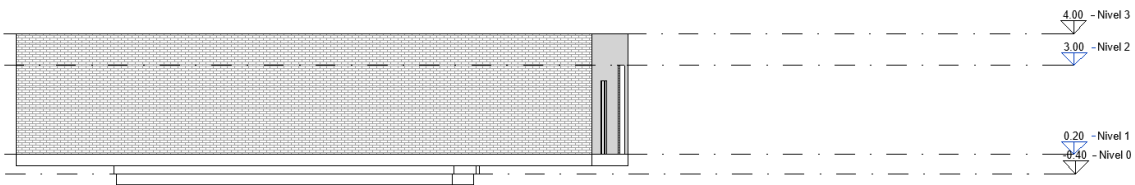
Alzado Norte modelo levantamiento con iPhone. Fuente: elaboración propia.
